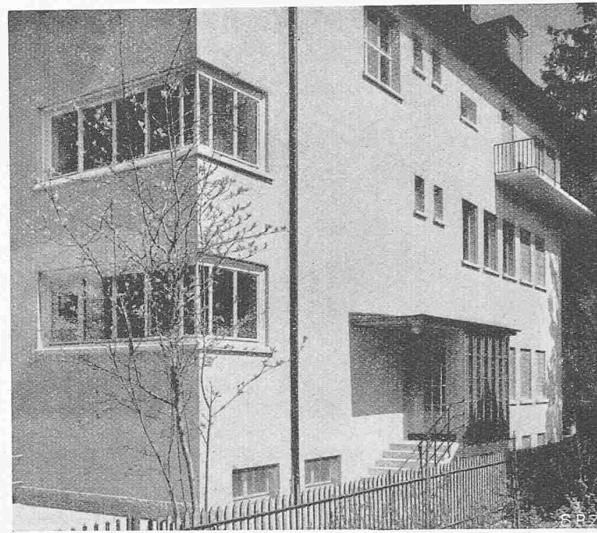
Südecke mit Treppenhaus im neuen Schulhaus
